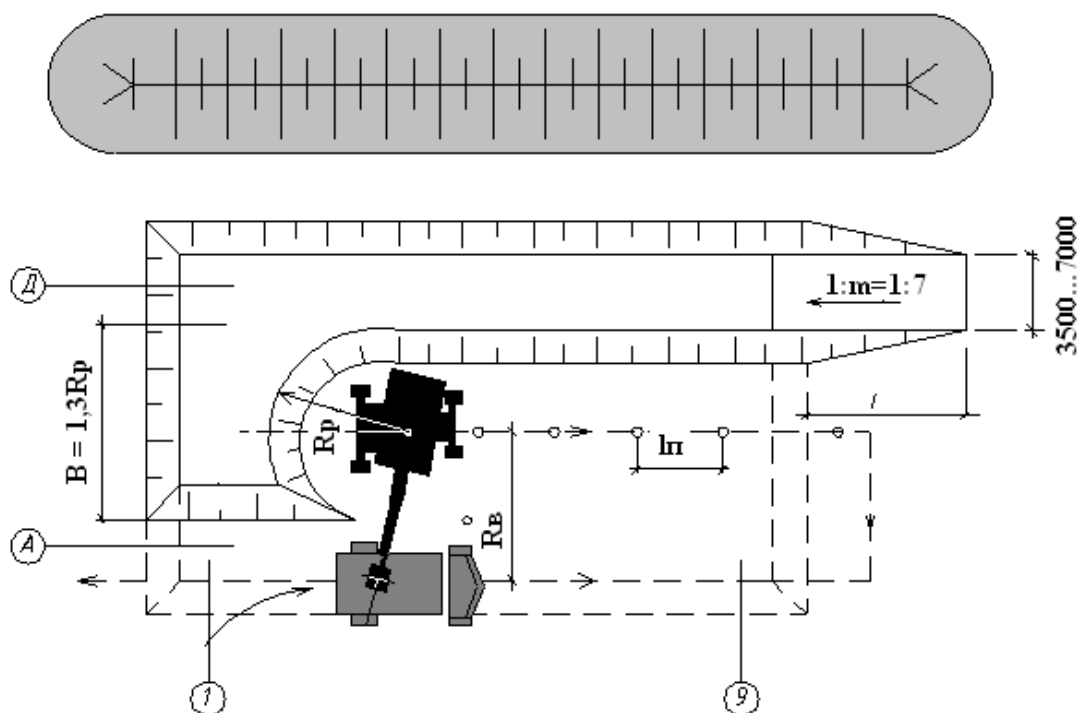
Схемы боковых проходок при устройстве котлована с погрузкой грунта в транспортные средства
